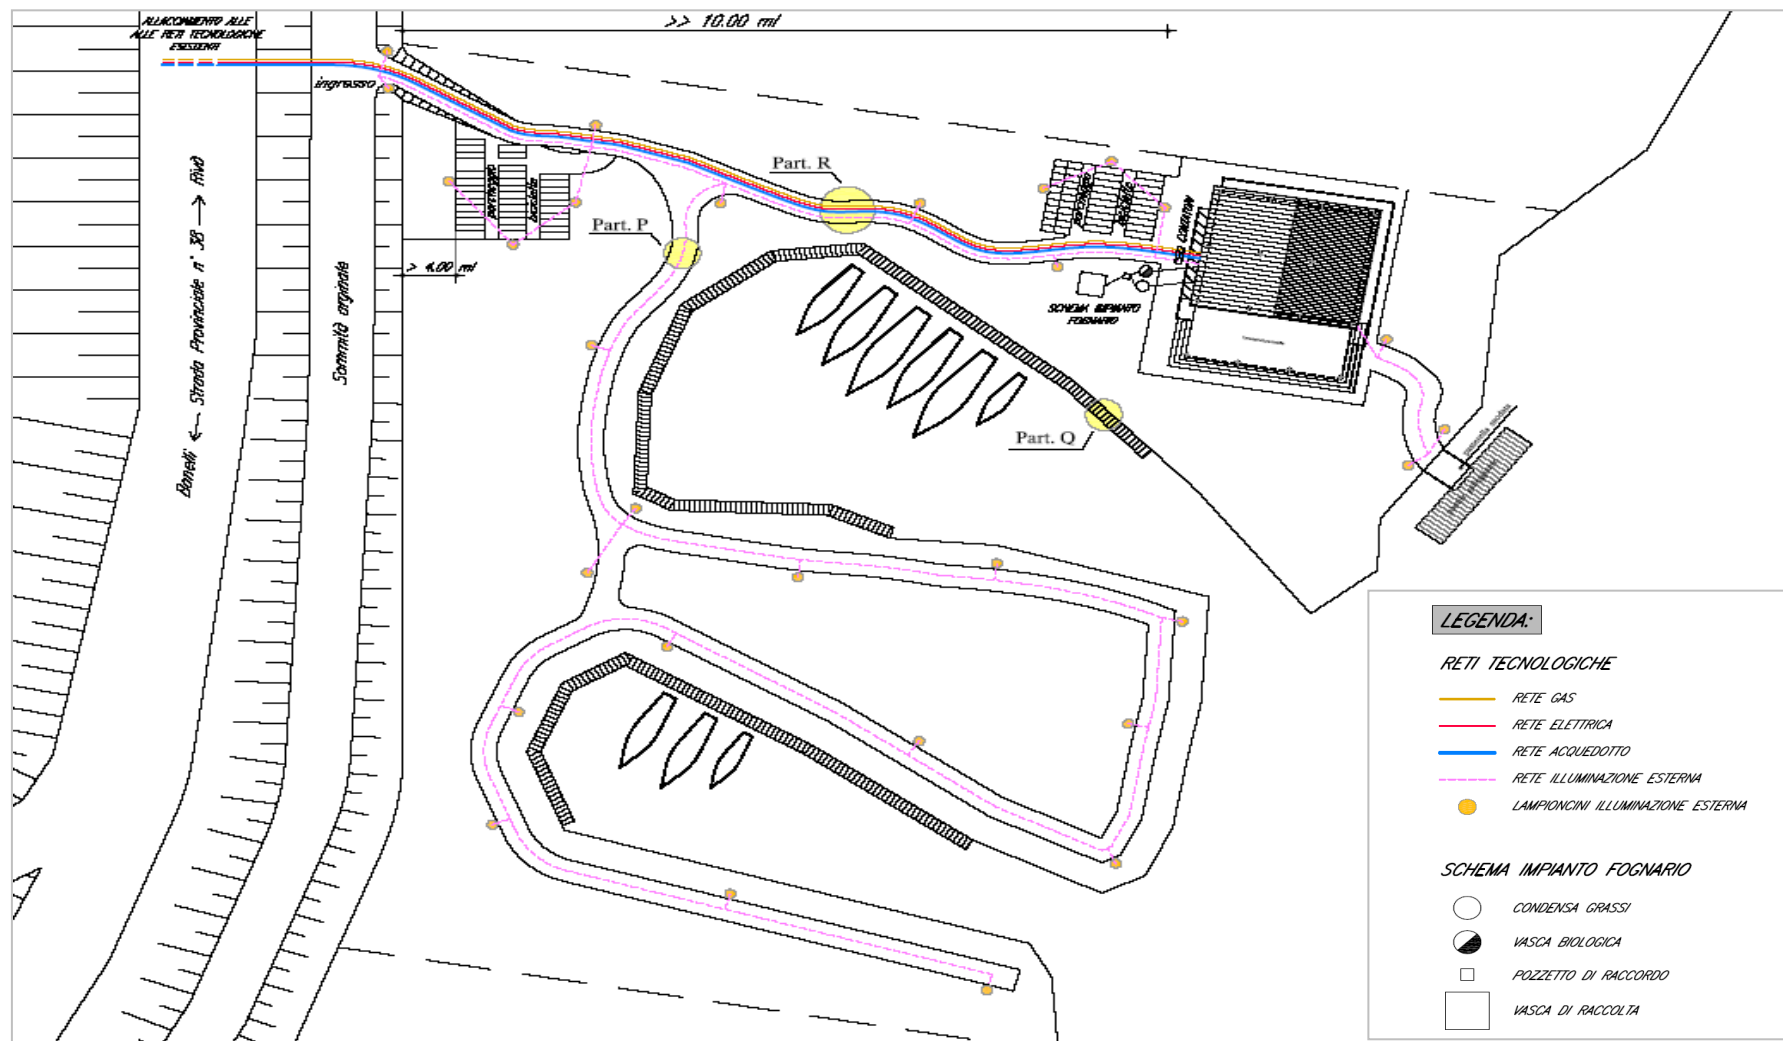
Planimetria relativa alle opere di urbanizzazione (sottoservizi).
